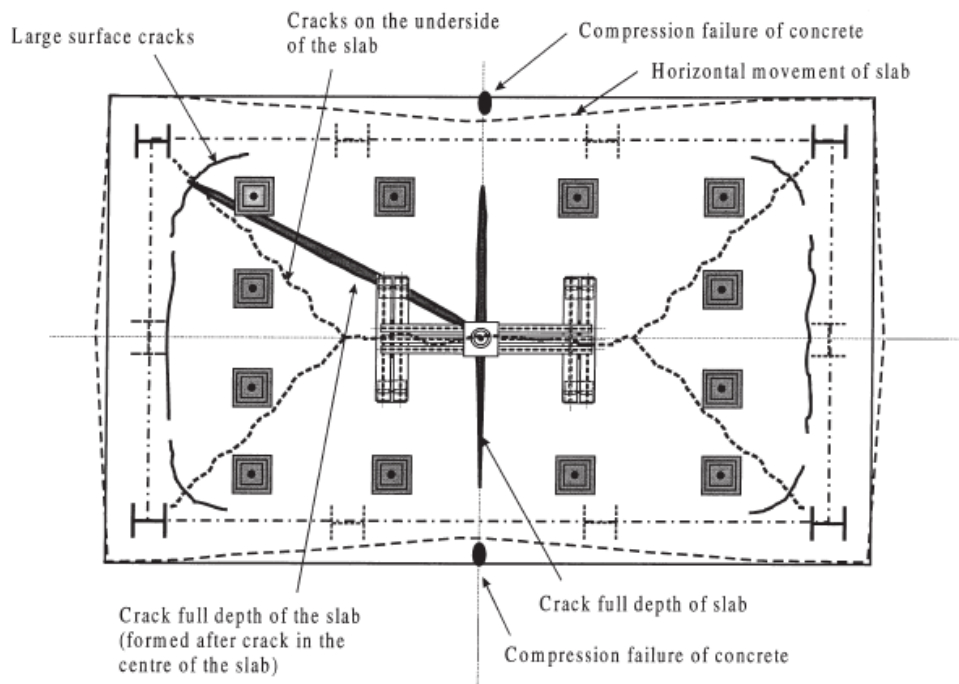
Rupturas da laje mista de C.G Bailey [4]
